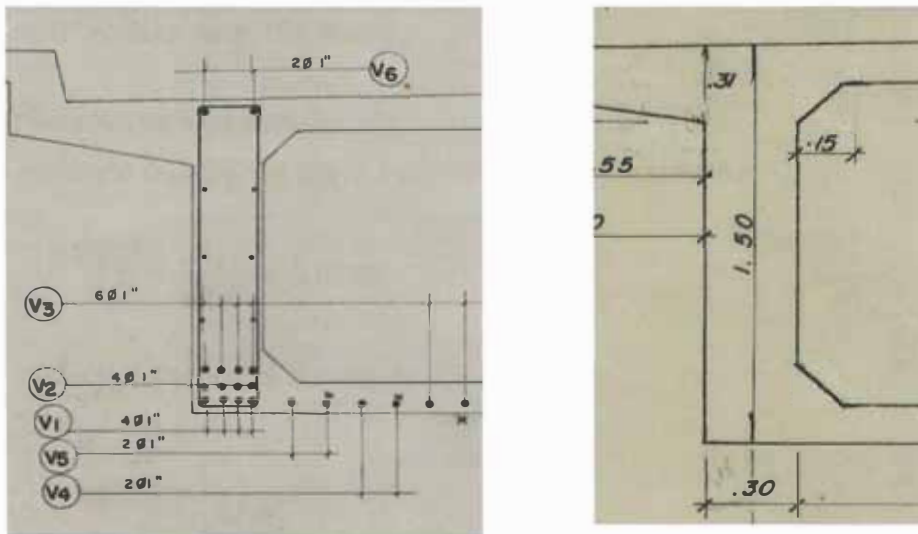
Vista de la sección de viga exterior con refuerzo para el momento positivo.
